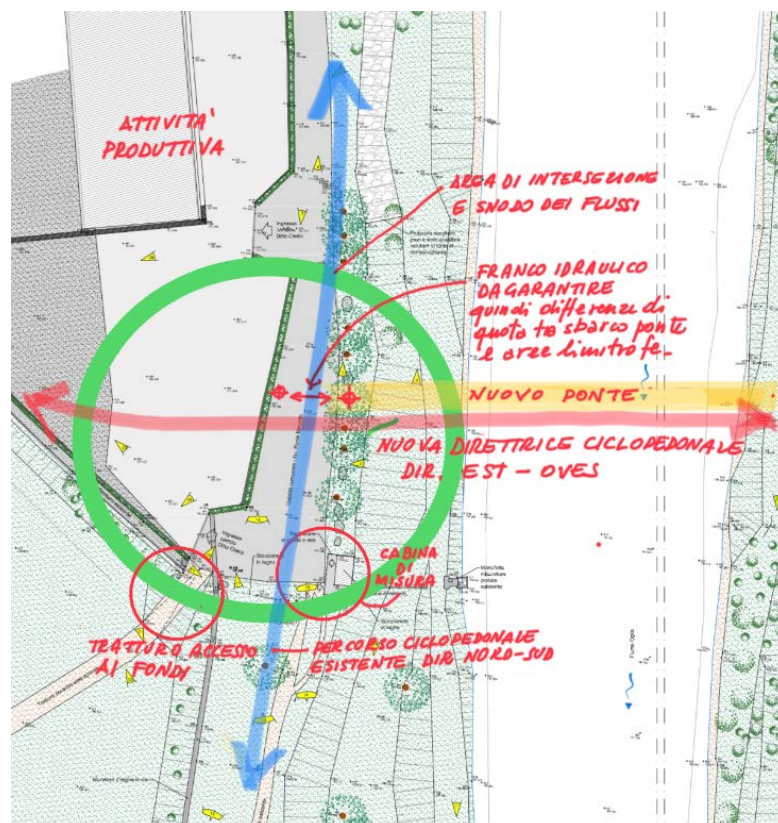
Esigenze e condizionamenti caratterizzanti la progettazione dell'accesso al ponte in sponda destra.
